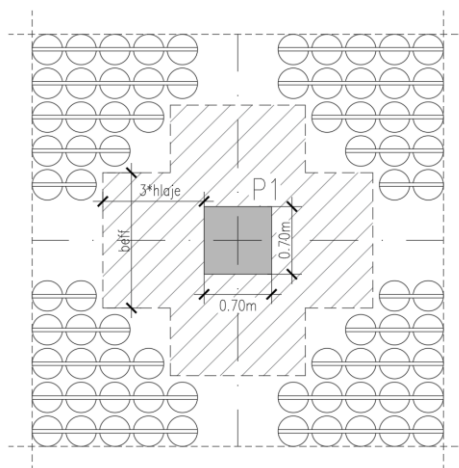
Dimensões mínimas da zona maciça pilar-laje.
